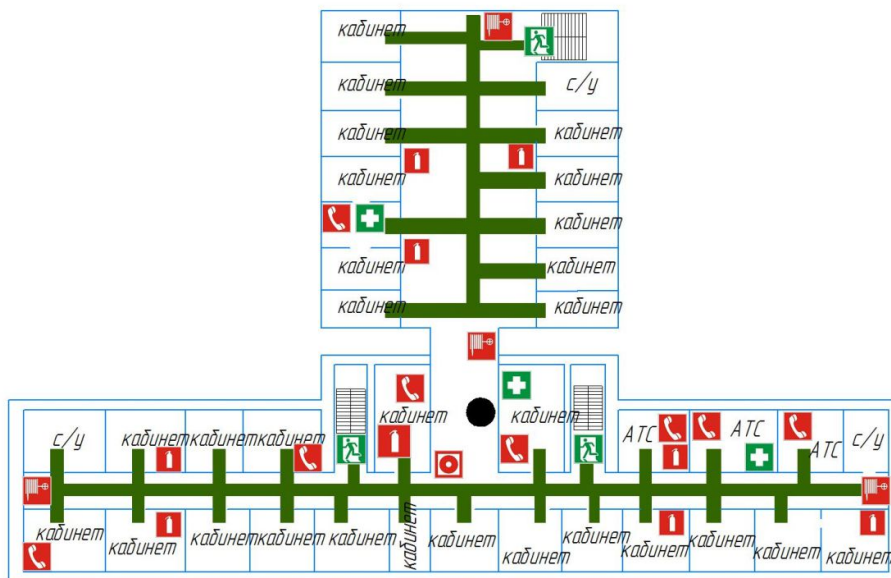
План эвакуации из помещений 2 этажа здания управления
